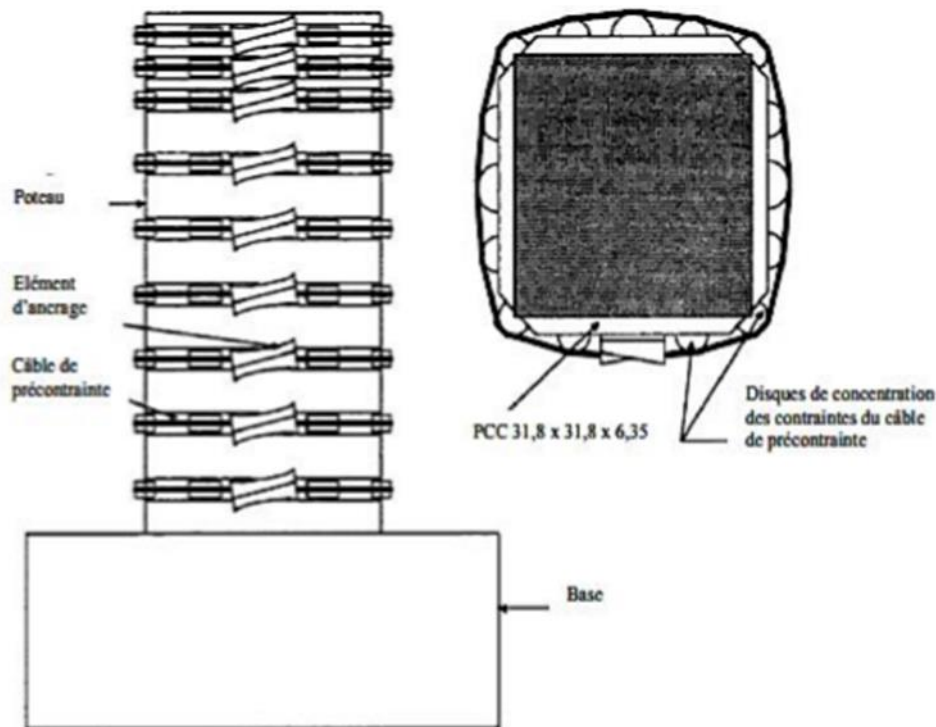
Détail d'un renforcement d'un poteau carré par précontraintes additionnelles. [(Kherkhache S). 2013]
